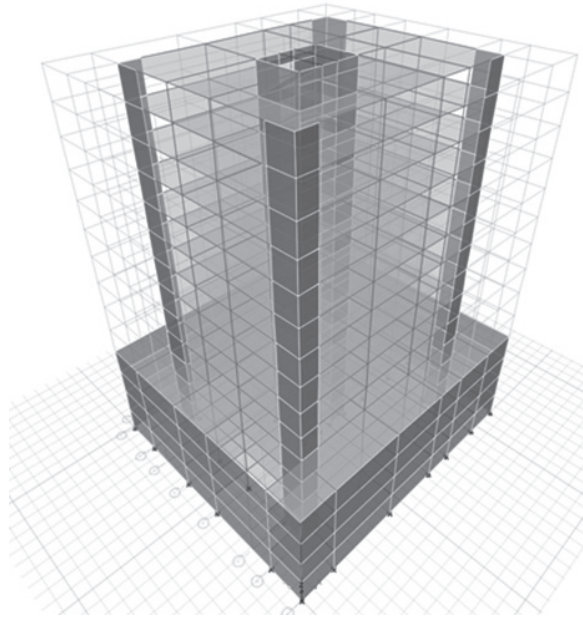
Modelo estructural para sistema de entepiso macizo sobre vigas.
